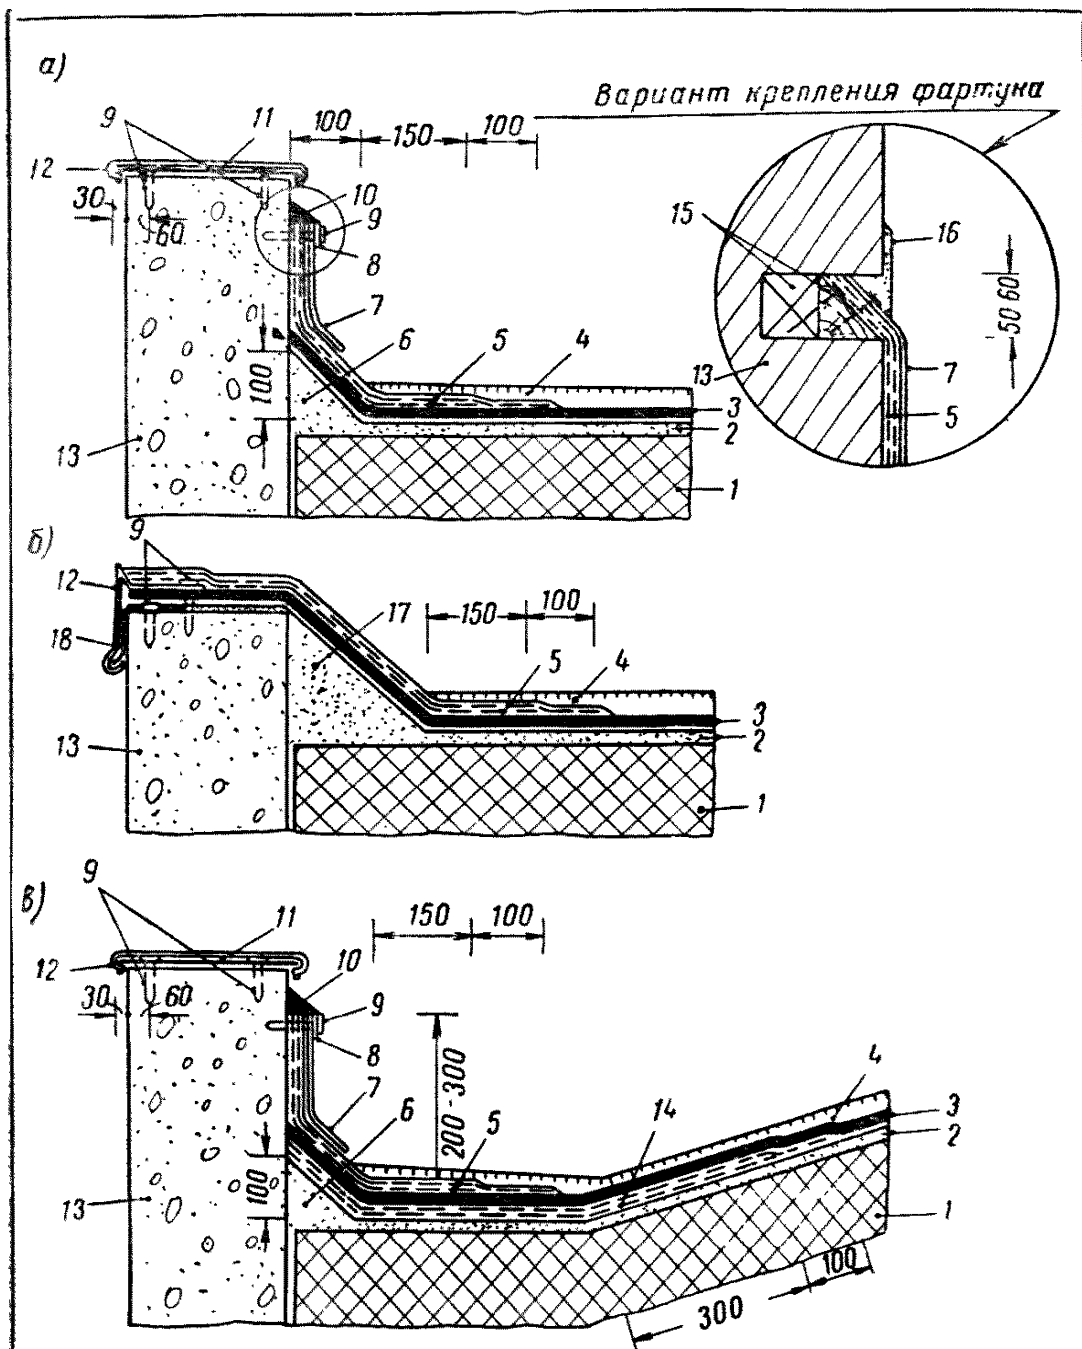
Примеры решения деталей примыкания мастичной кровли к парапету
